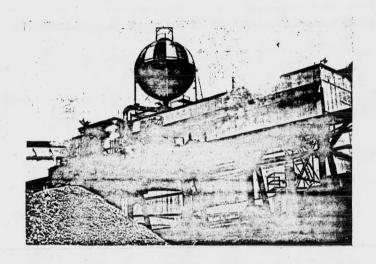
BOQUILLA DE GAS PARA DIGESTOR AUXILIAR Y QUEMADOR DE GAS.
